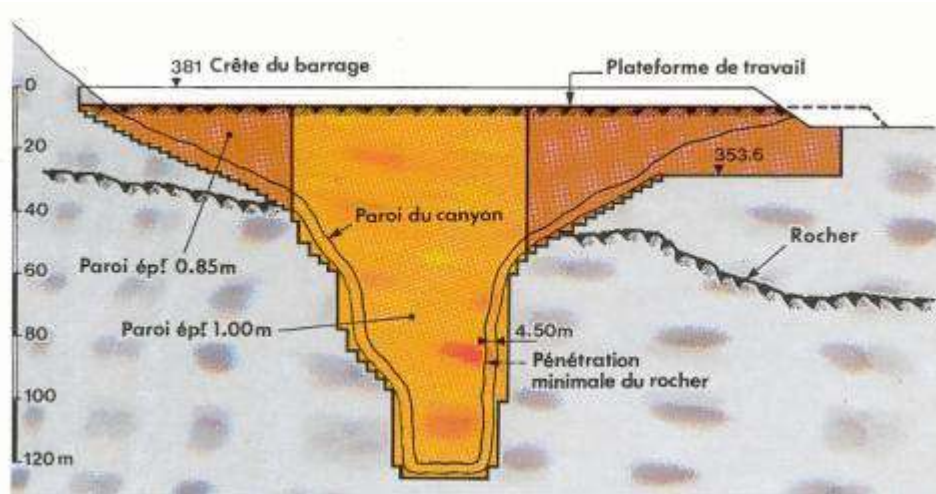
Barrage de Mud Mountain - USA – 1941
